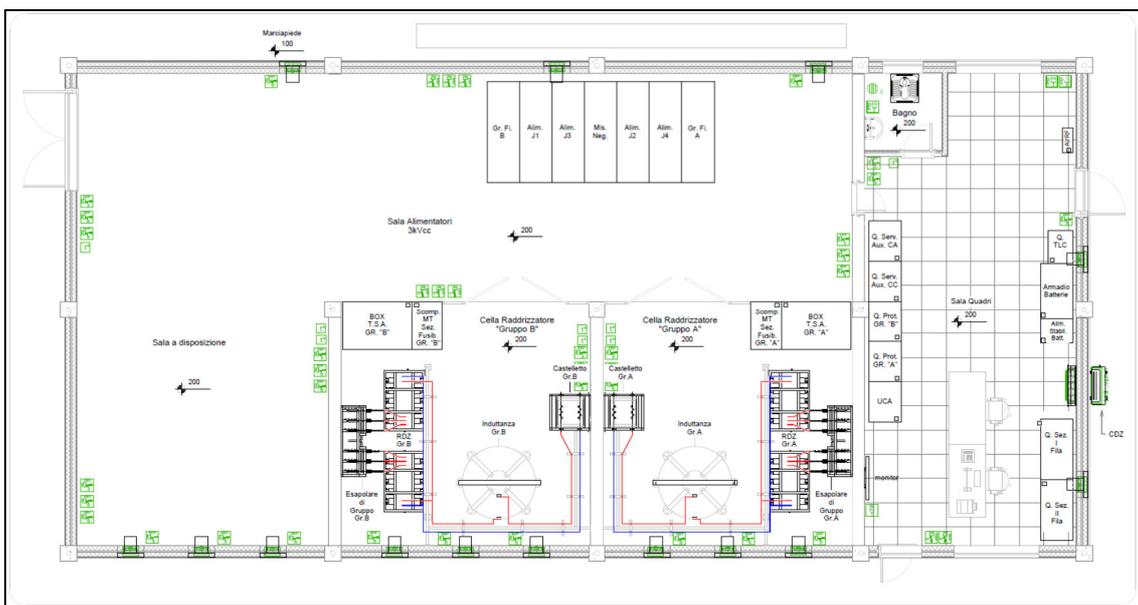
Planimetria impianto forza motrice del fabbricato
